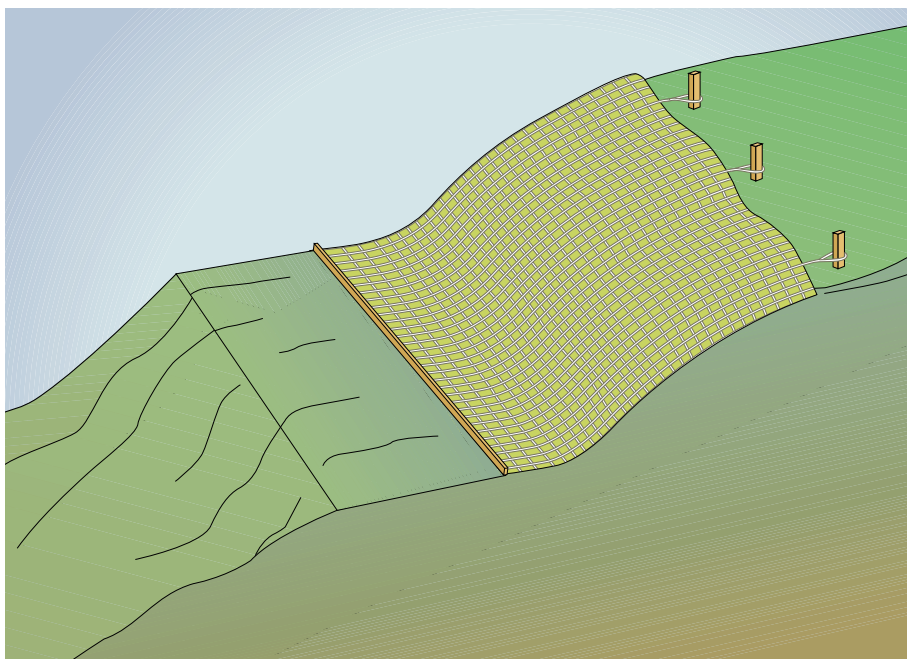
Escavação protegida – com estruturas denominadas “cortinas”
